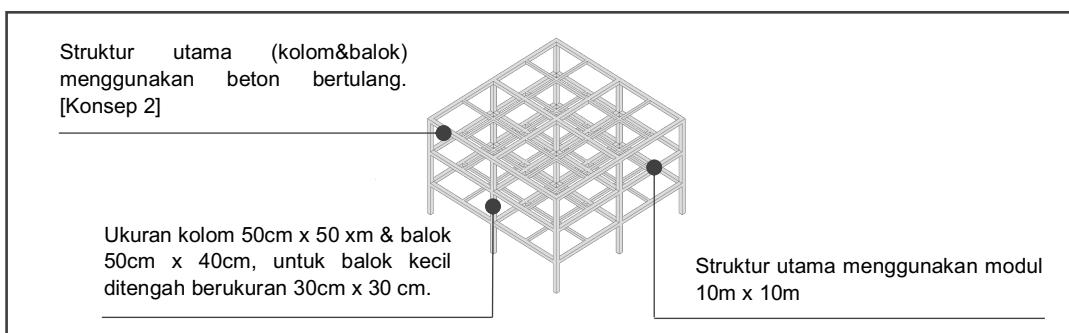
Bangunan olahraga, Sumber : Dok.Pribadi.
